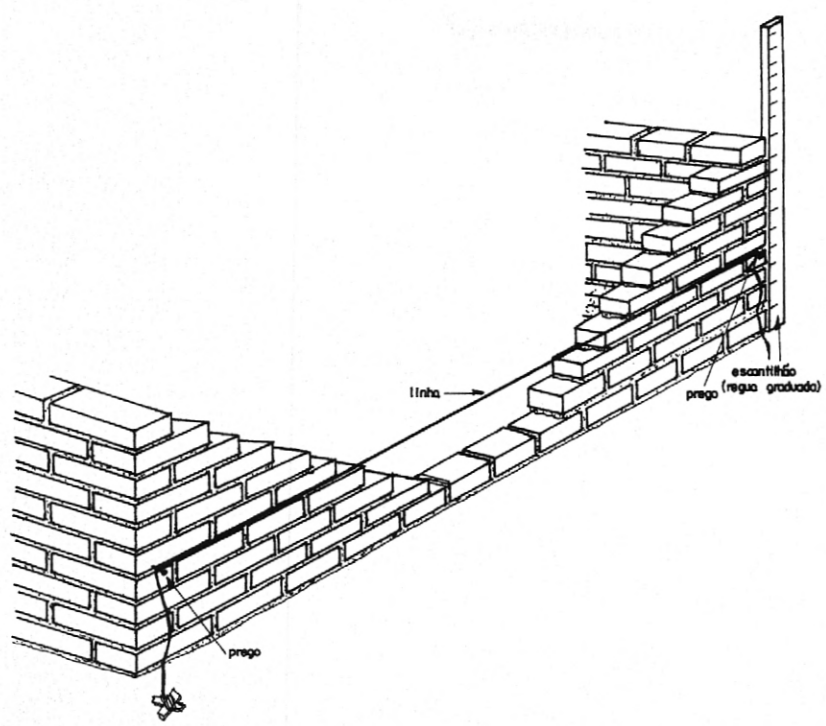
Detalhe do nivelamento da elevação da alvenaria.
